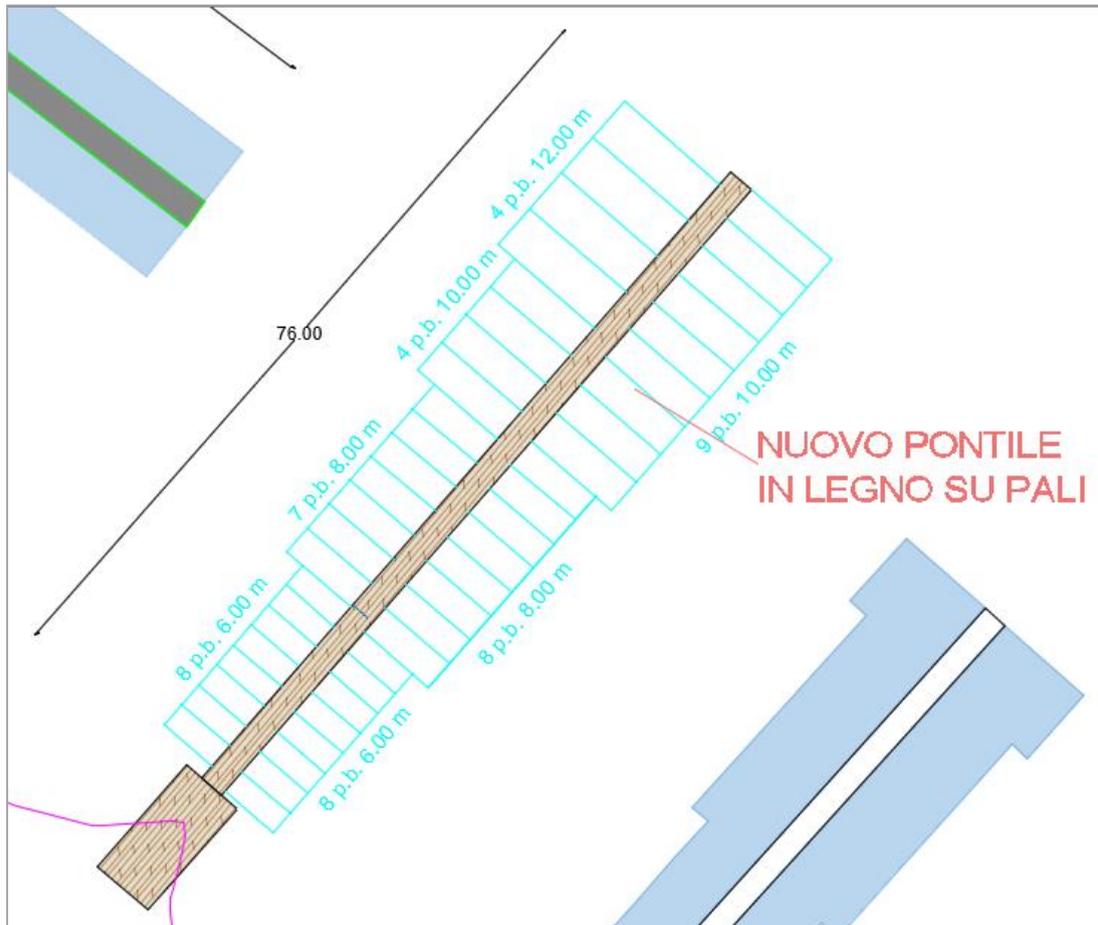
Stralcio planimetrico nuova struttura di ormeggio
